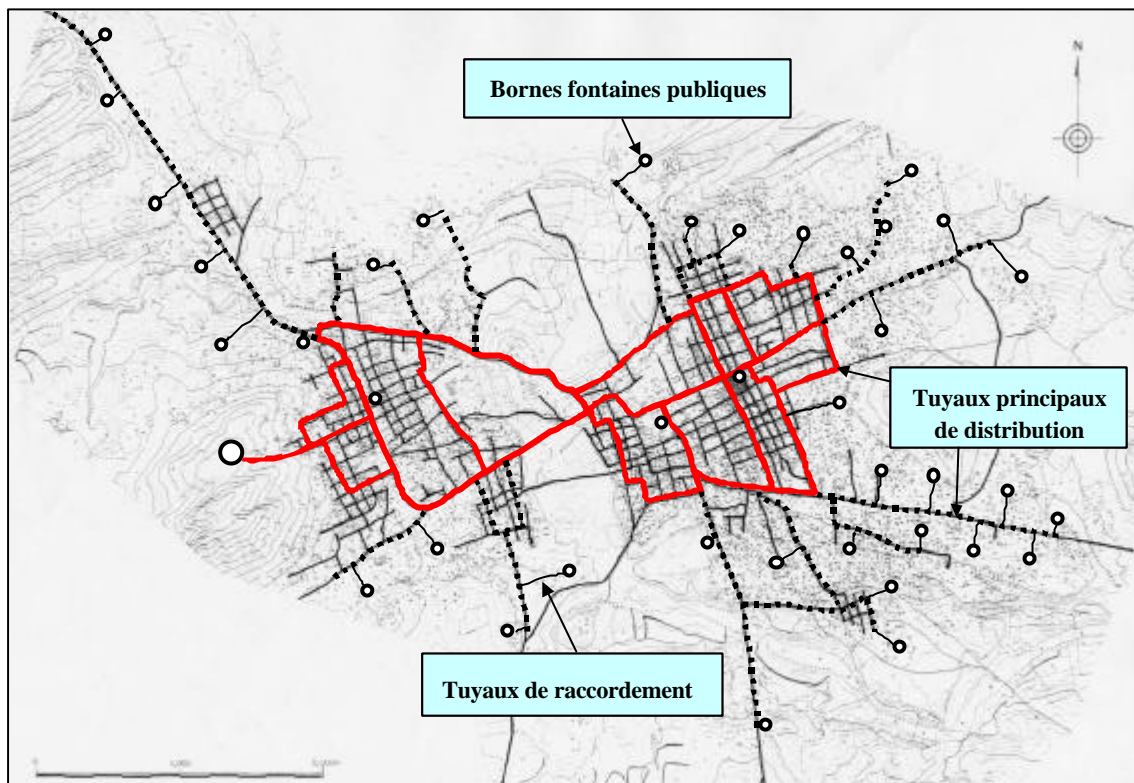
Plan de disposition des bornes fontaines publiques
